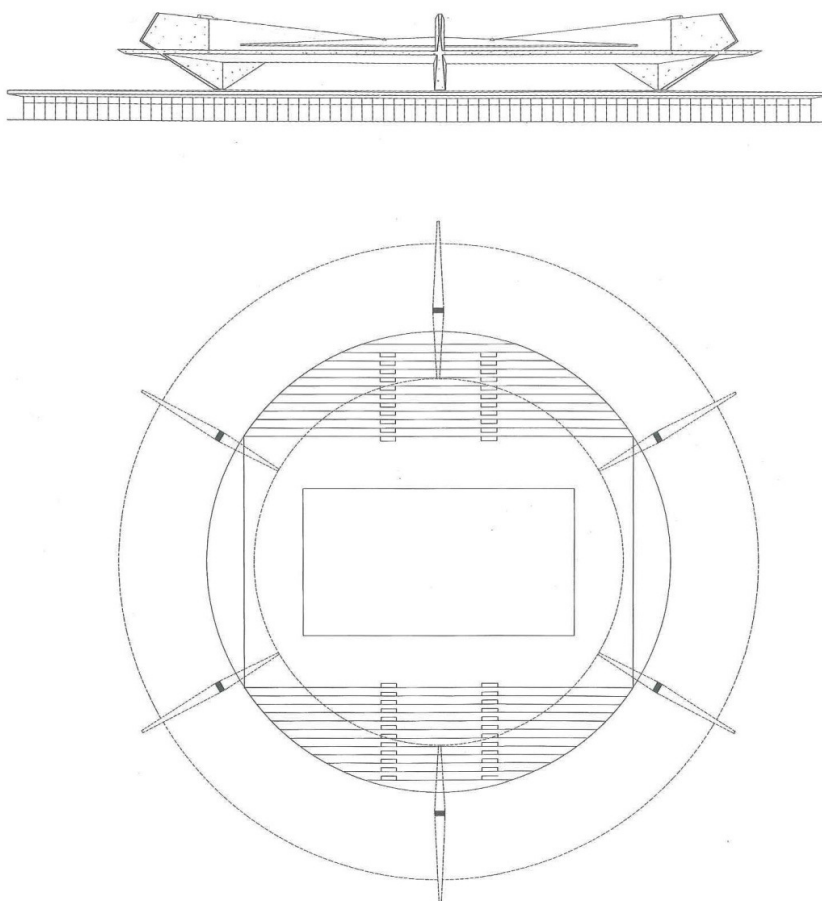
Planta de cobertura e elevação do Clube Atlético Paulistano.
